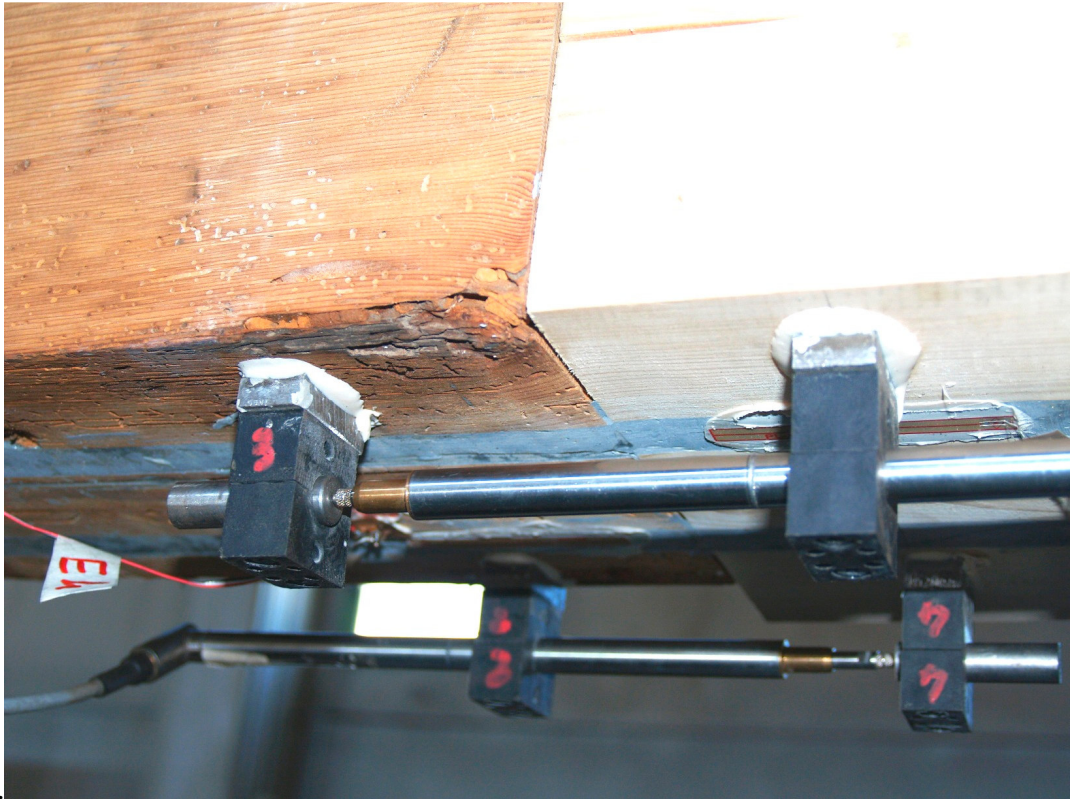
disposizione degli LVDT nella zona di giunzione
